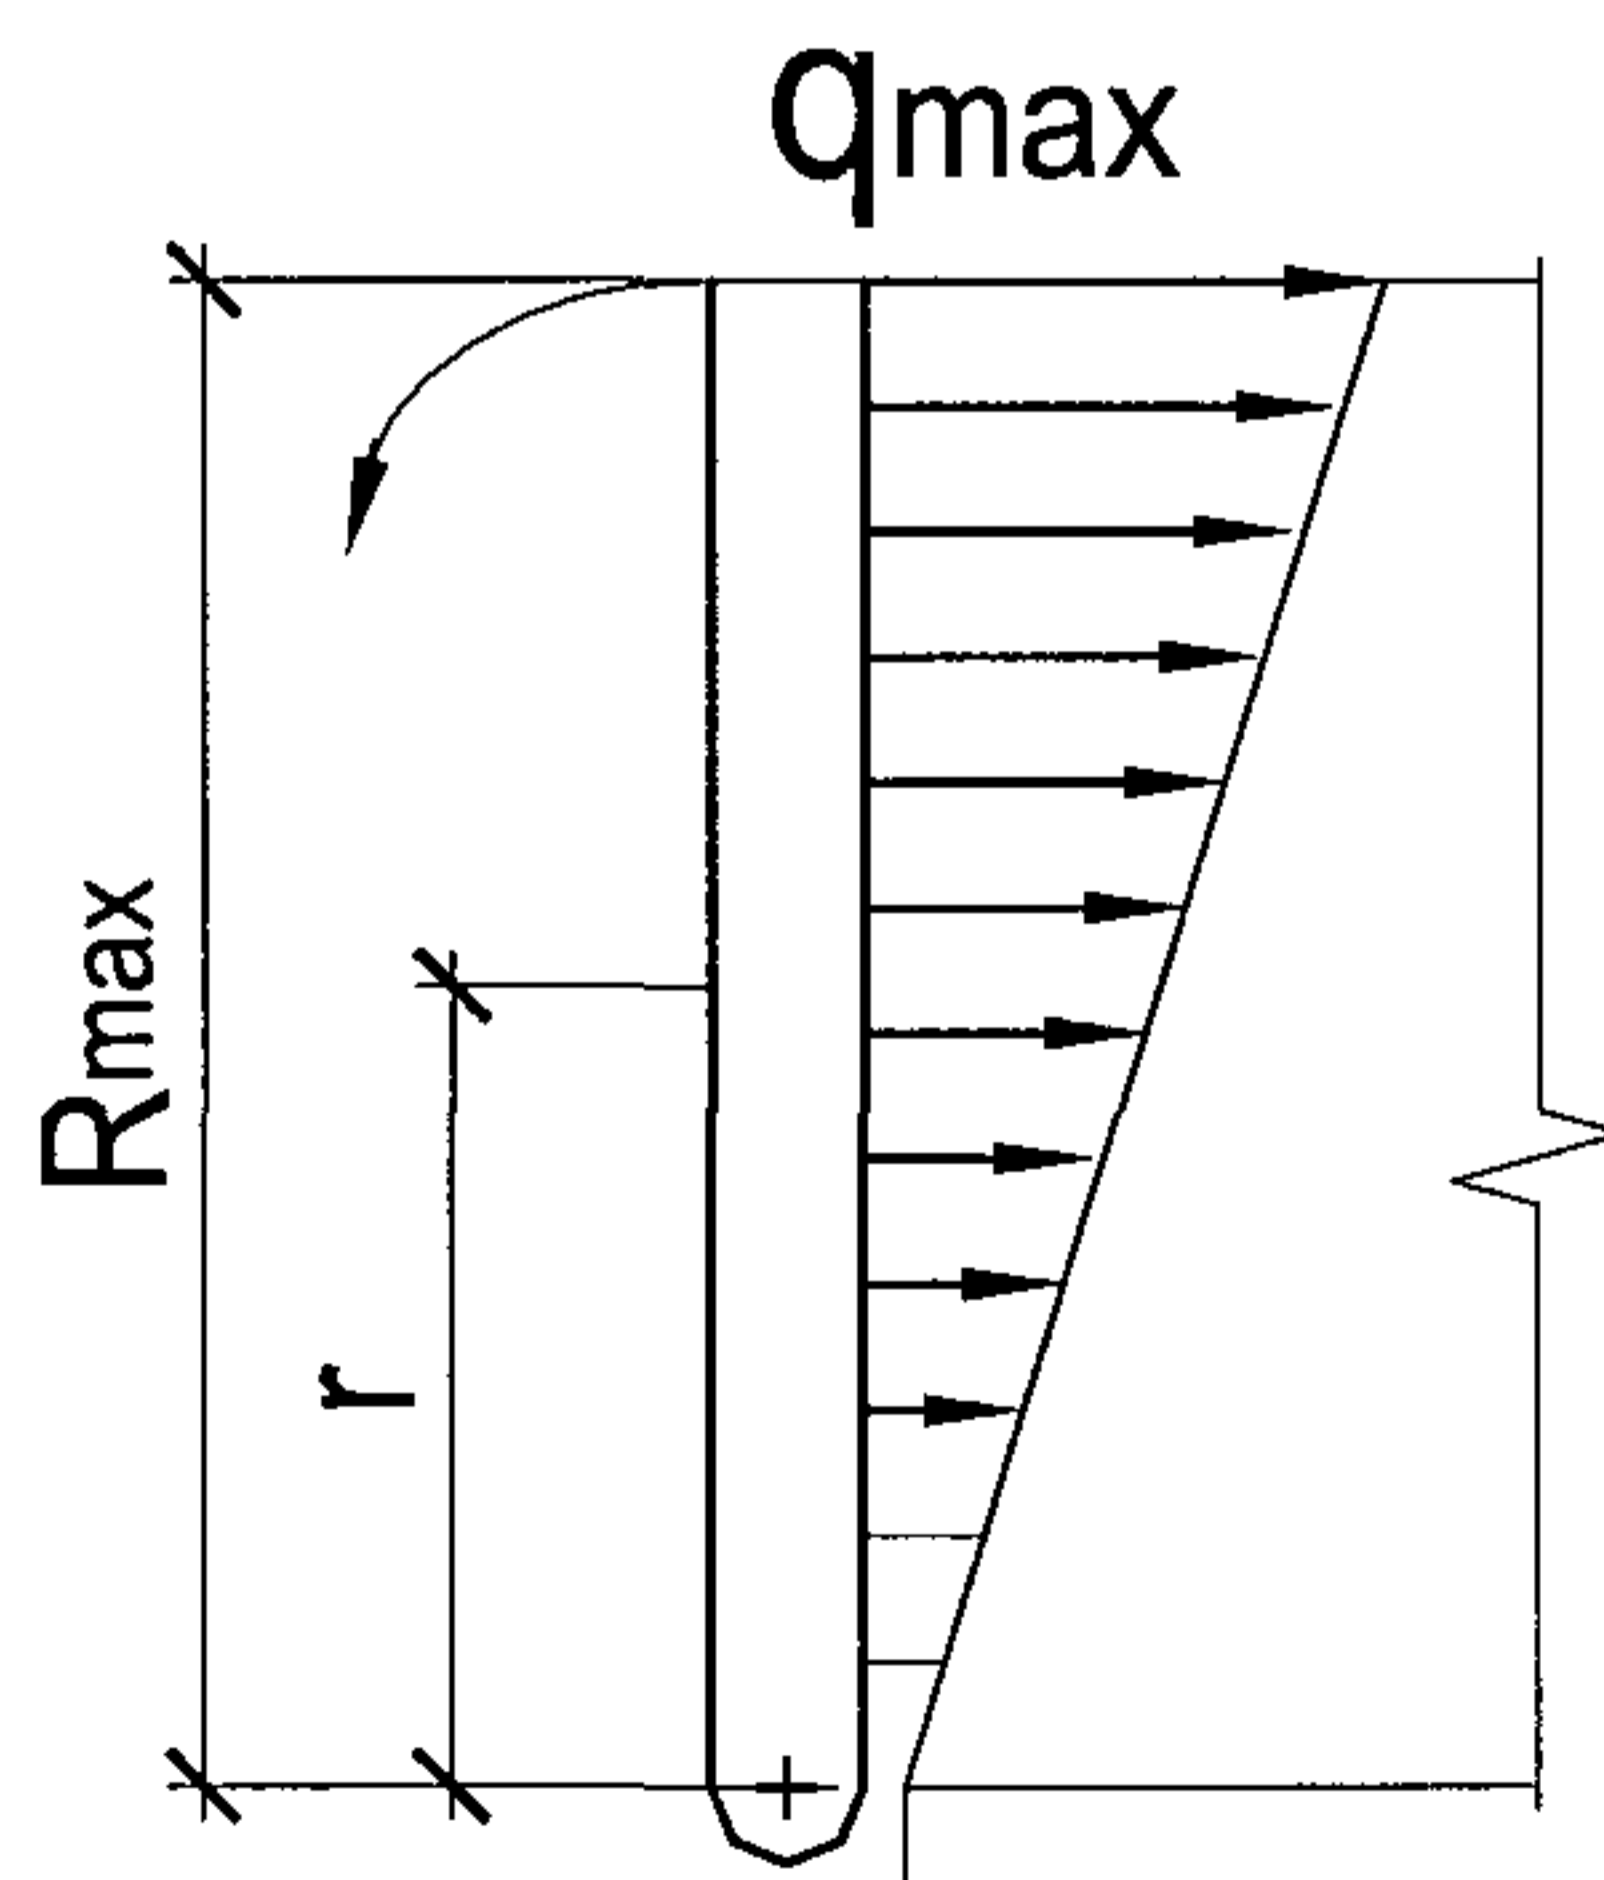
Расчетная схема давления для определения сцепления с бетоном прямоугольного участка опалубки
